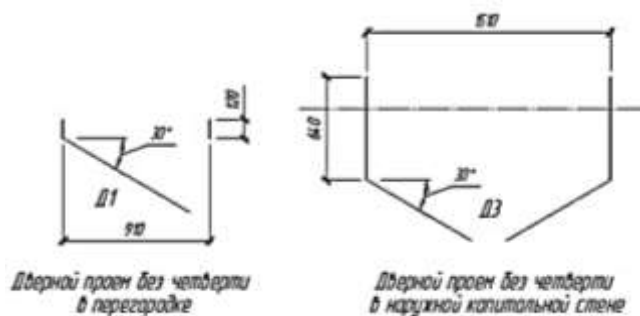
Пример изображения дверного проема на плане этажа здания
